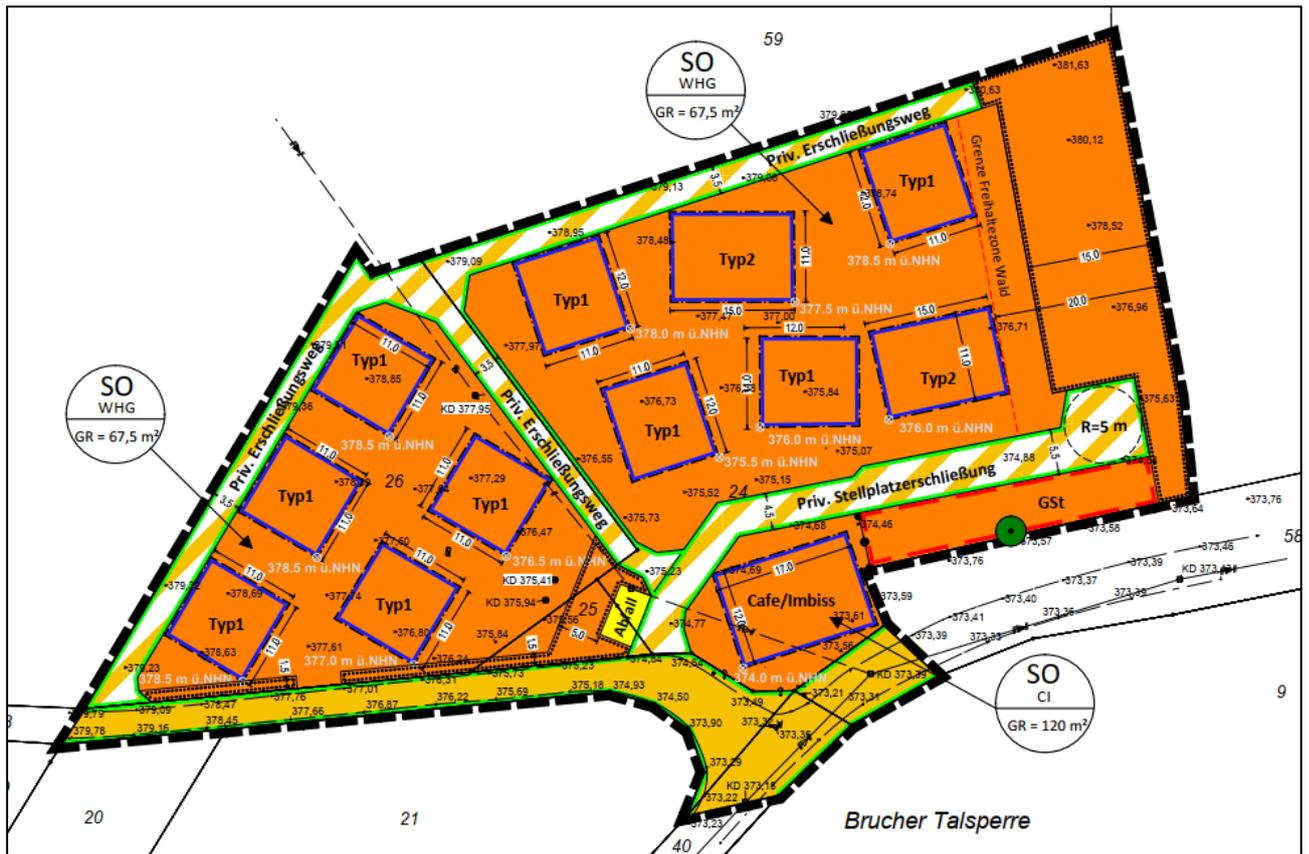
Planzeichnung Bebauungsplan, Quelle: HKS, 2023
